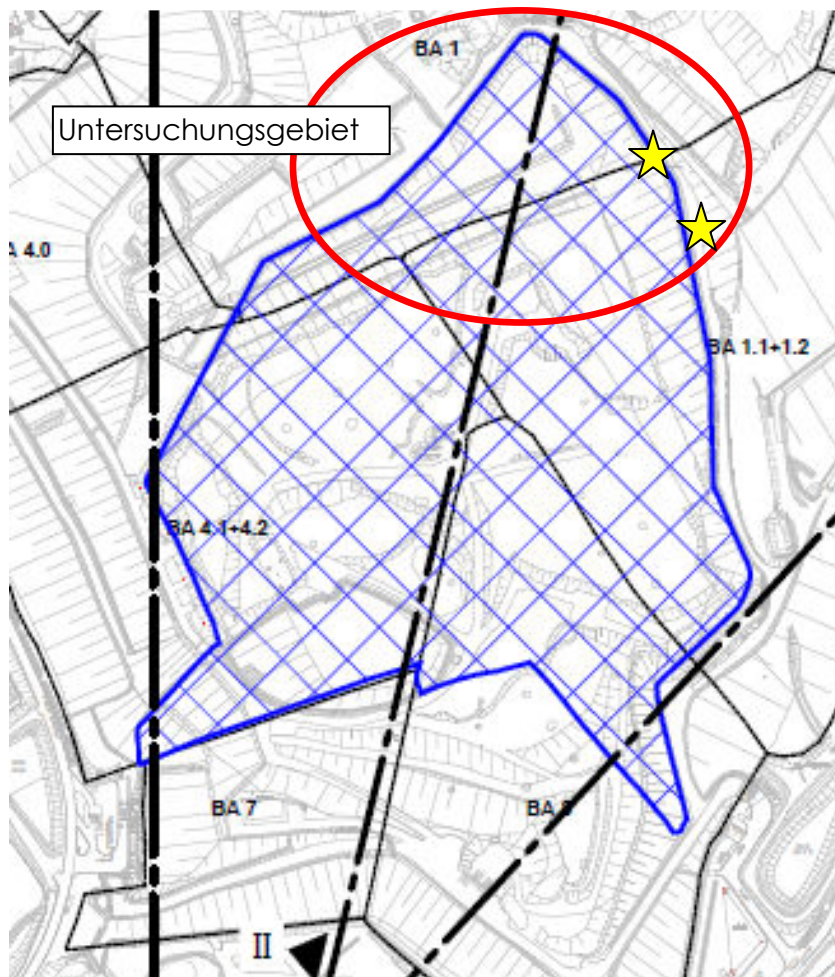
Lageplan der MFA mit Schnittverläufen
